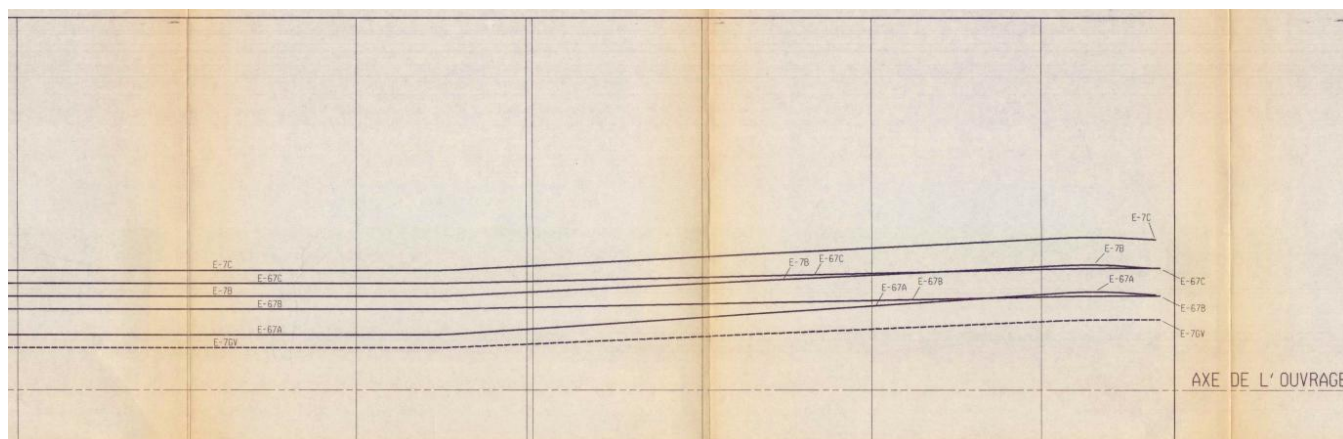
Extrait de la vue en plan des câbles extérieurs sur la travée 7 - P457
